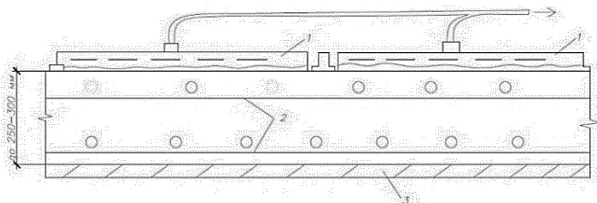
Схема вакуумной обработки бетона в плитах толщиной до 250-300 мм:
